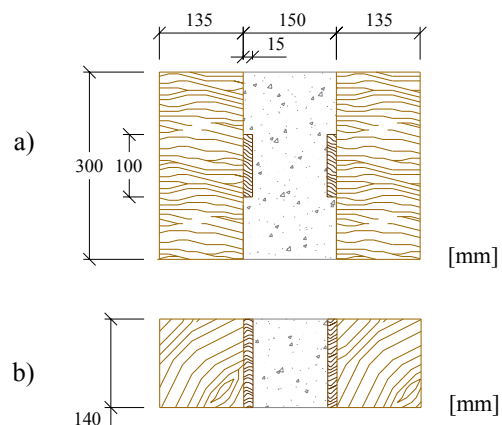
Dimensões dos elementos que compõem os provetes Pinho 140mmx100mmx15mm: a) alçado; b) planta
